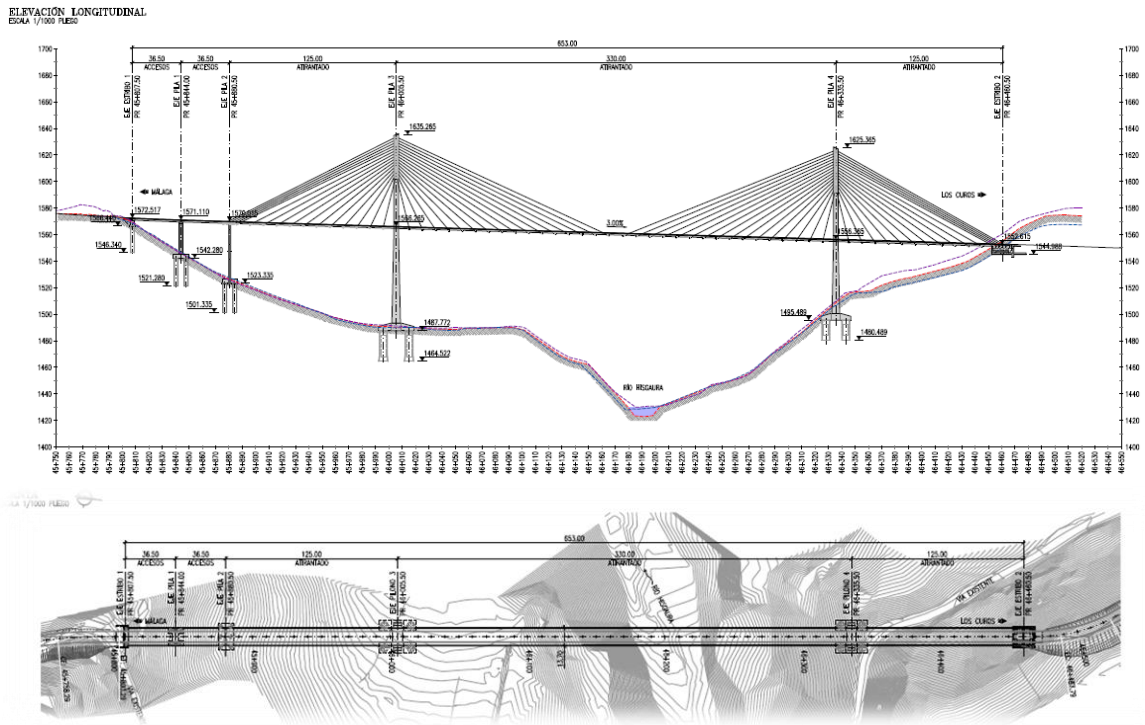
Planta y Elevación Puentes Atirantados Hisgaura
